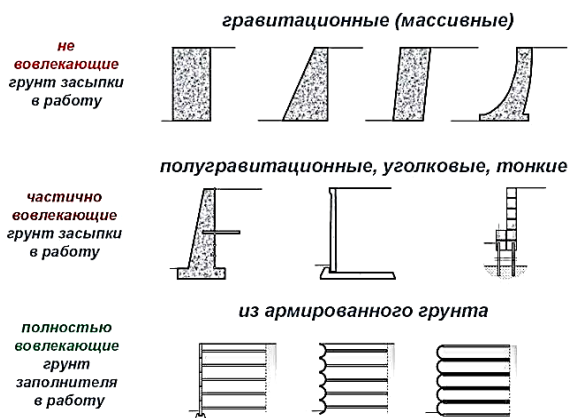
Классификация подпорных стен по степени участия удерживаемого грунта в их работе
